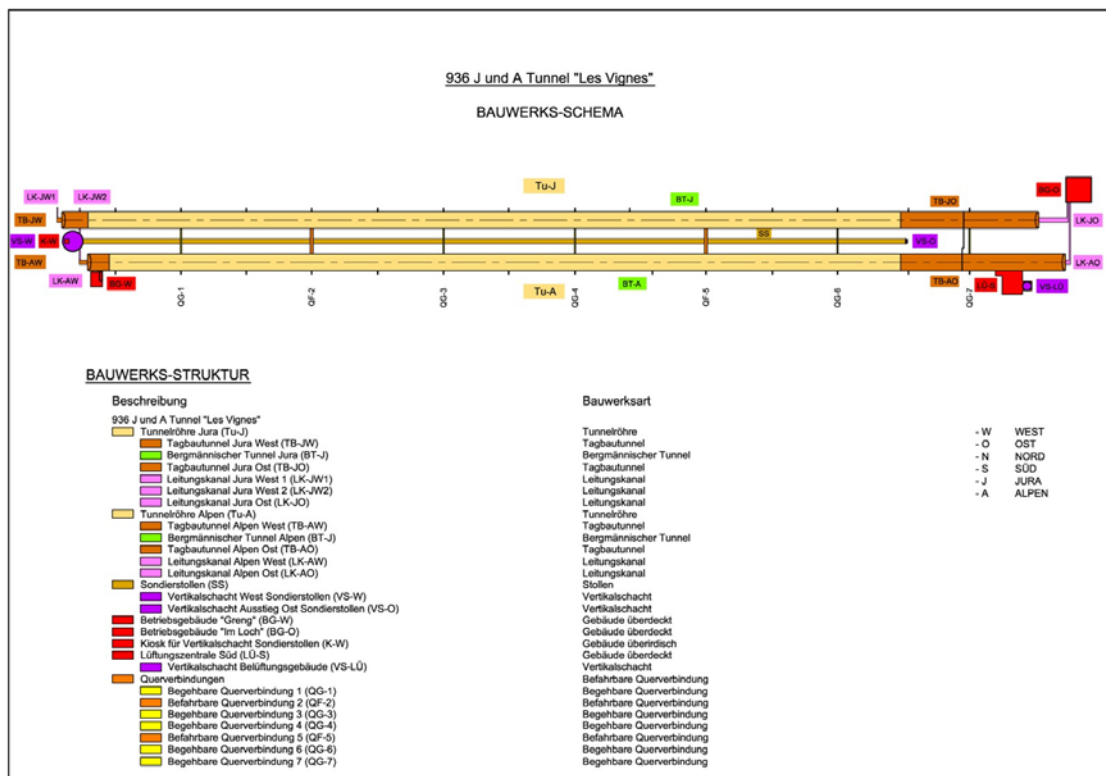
Schritt 1, Skizze der Tunnelanlage „Les Vignes“.
